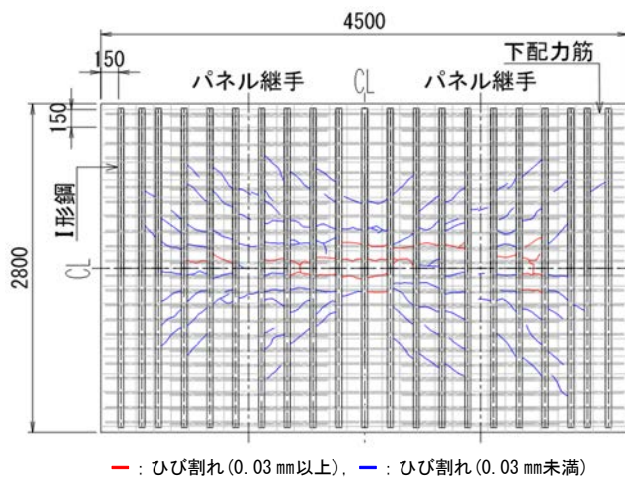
試験終了時の床版下面のひび割れ状況（寸法単位：mm）
